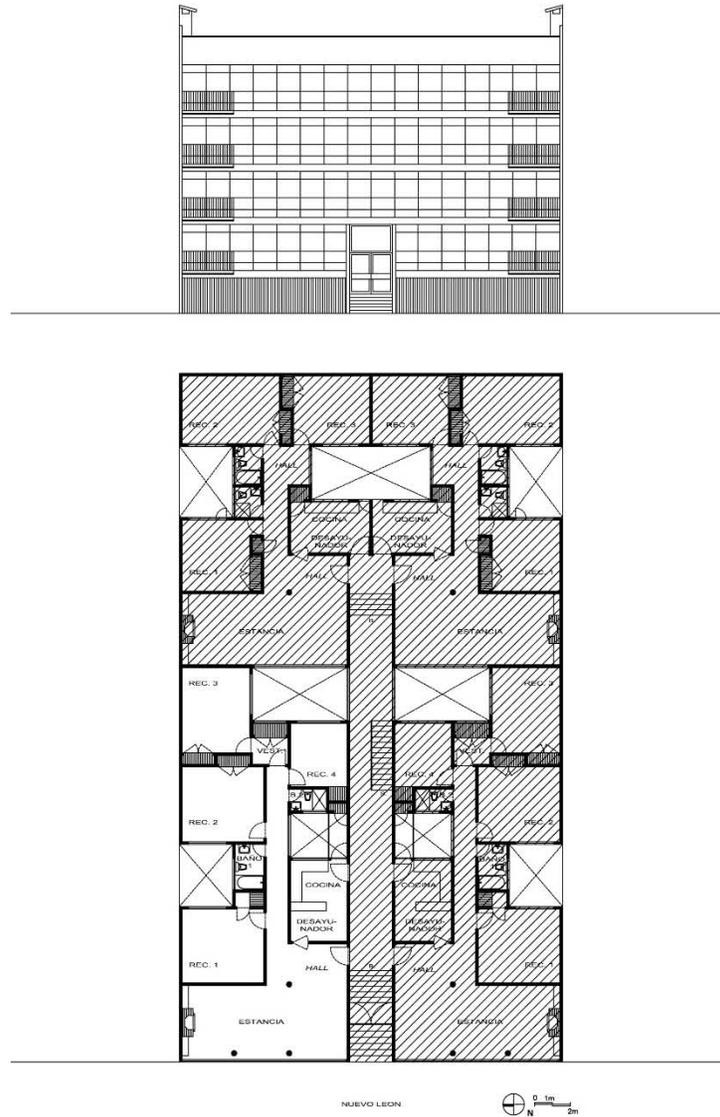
Fachada y planta del edificio ubicado en Nuevo León núm. 240
